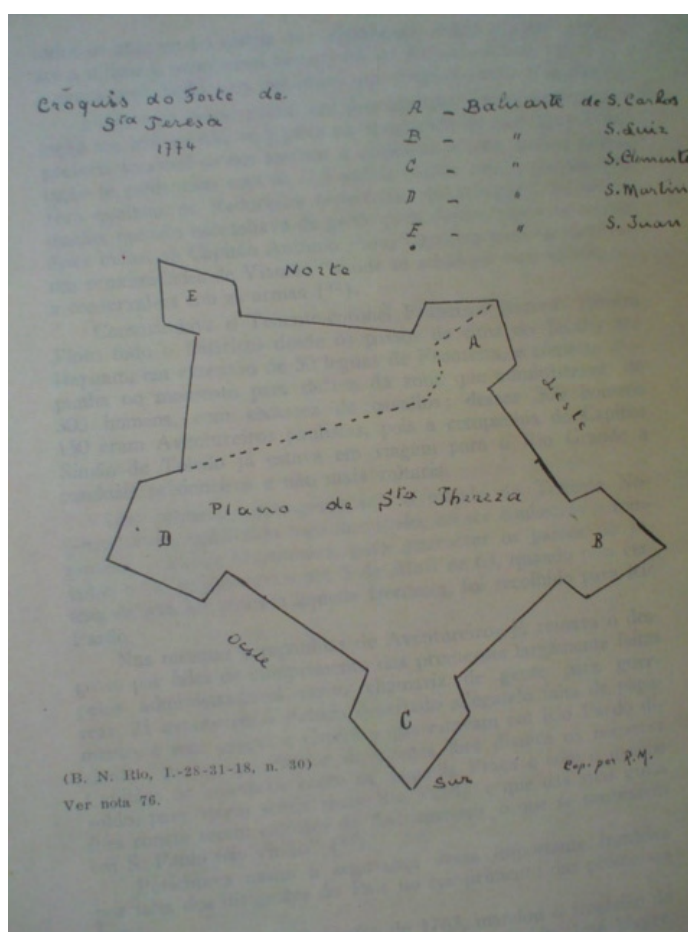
Planta 2 - Croqui de Santa Teresa (1774)
